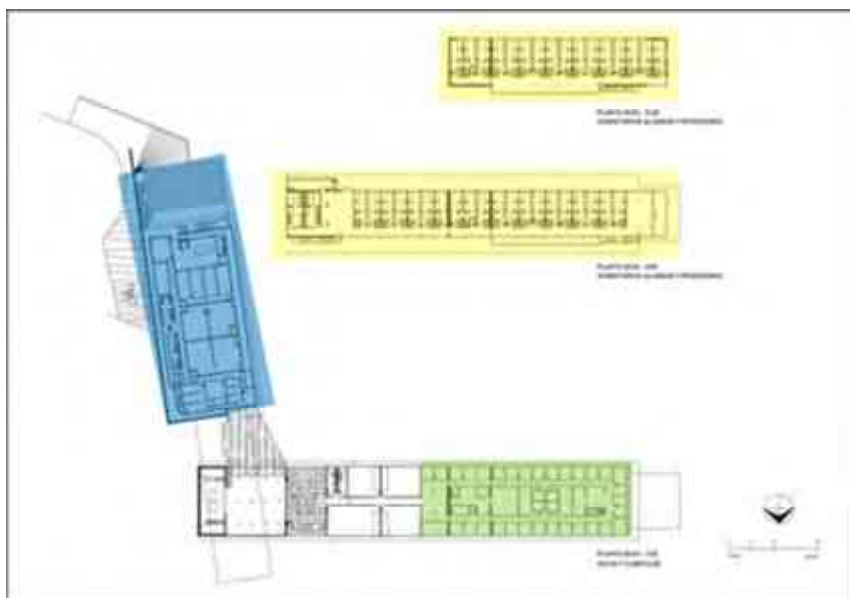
Planta arquitectónica baja con aulas y dormitorios, imagen obtenida de la página <http://www.archdaily.mx/62219>, 23-10-2012.
